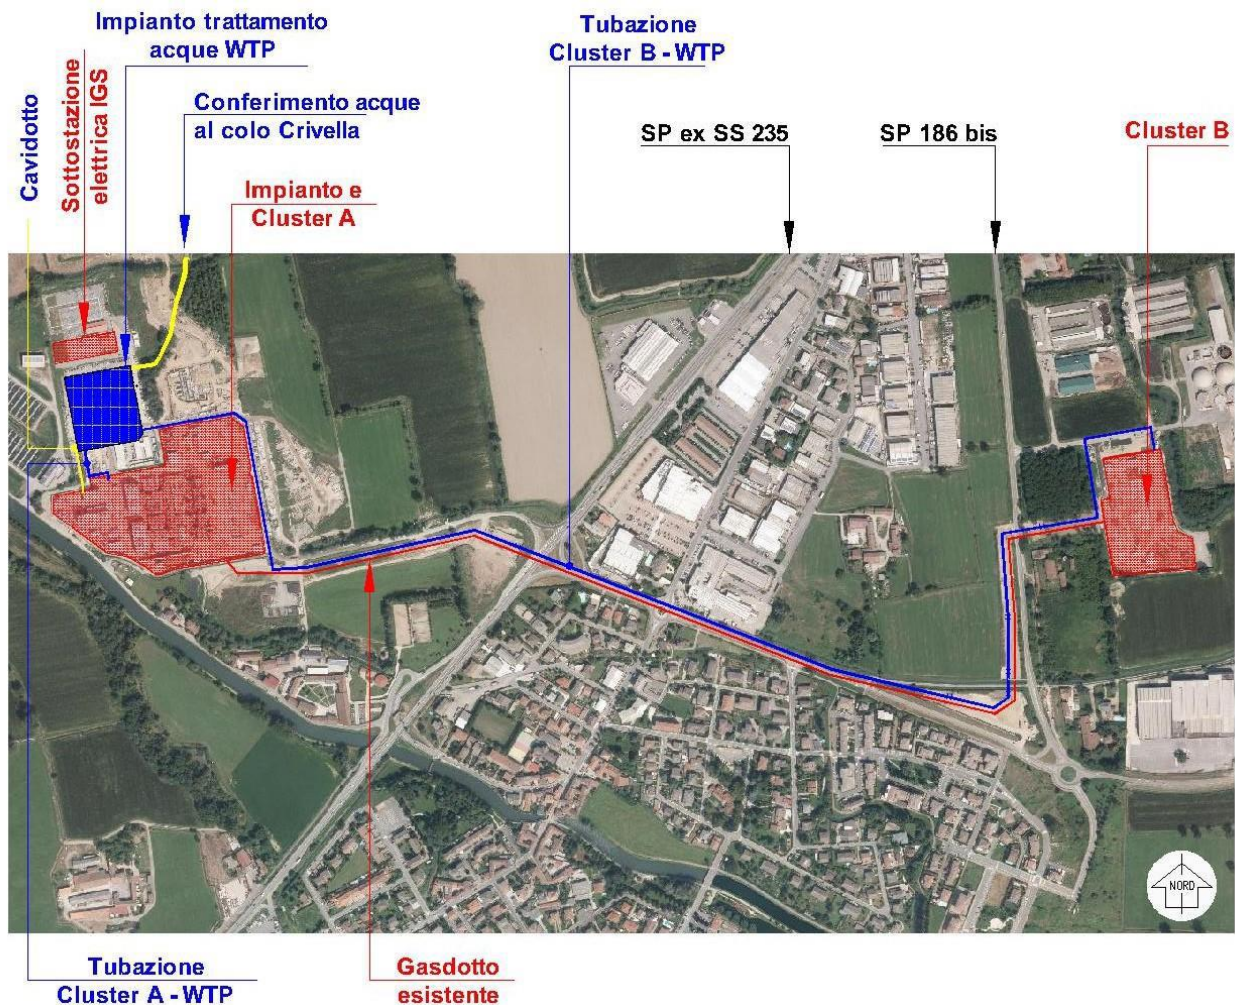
Schema generale inserimento impianto WTP nell'areale di progetto
